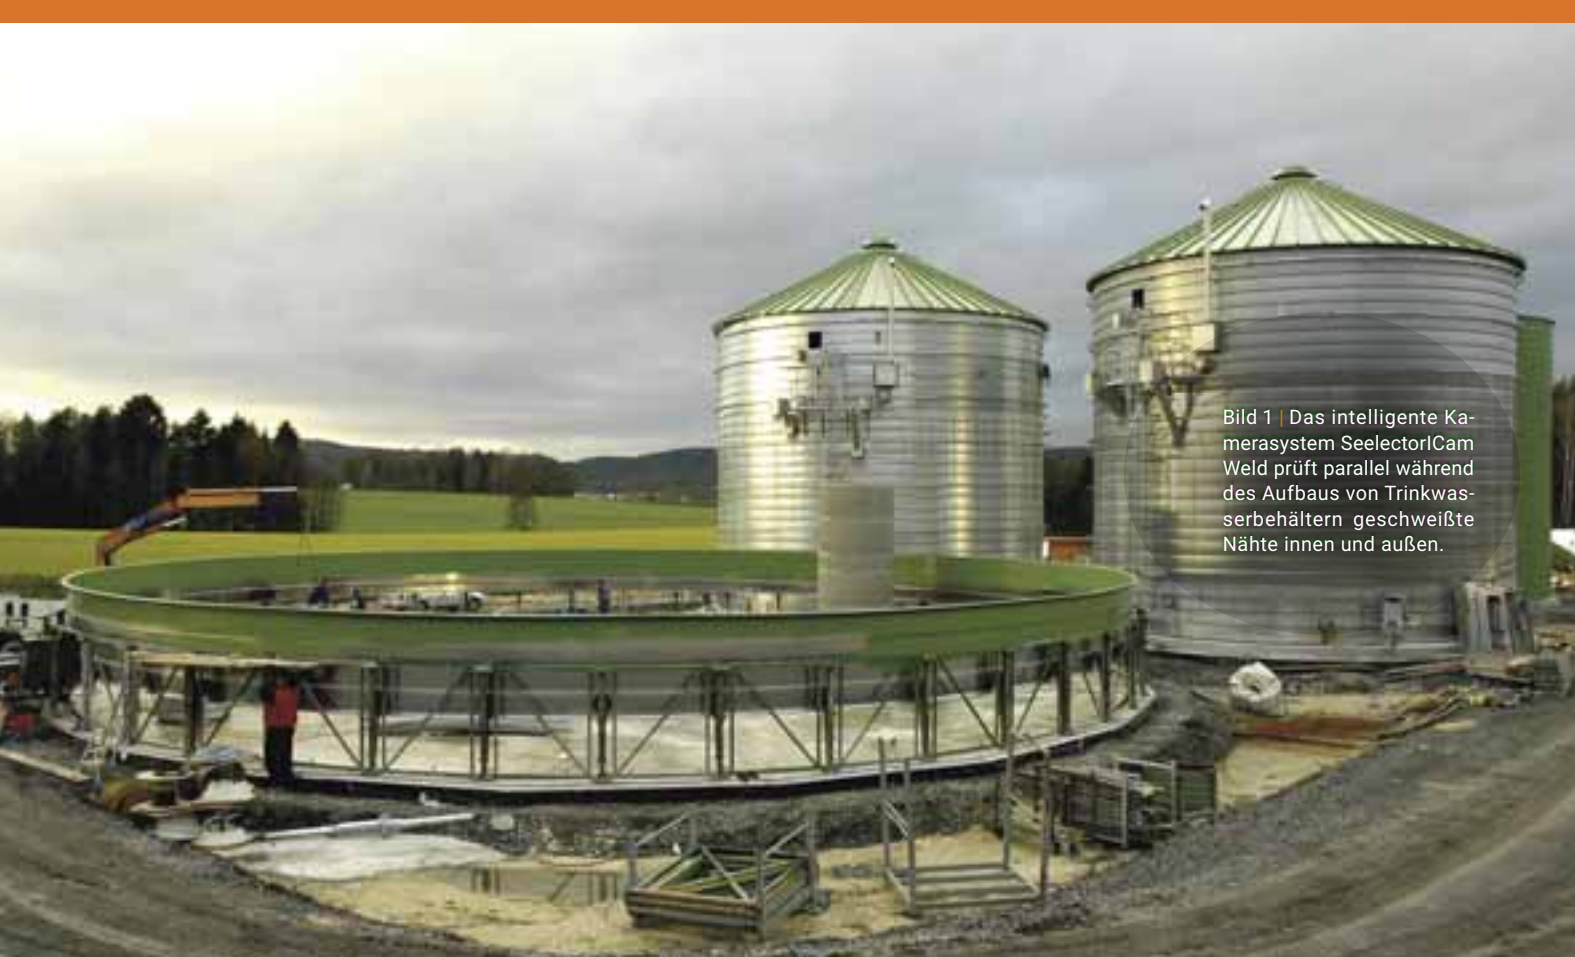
| Das intelligente Kamerasystem SeelectorICam Weld prüft parallel während des Aufbaus von Trinkwasserbehältern geschweißte Nähte innen und außen.
